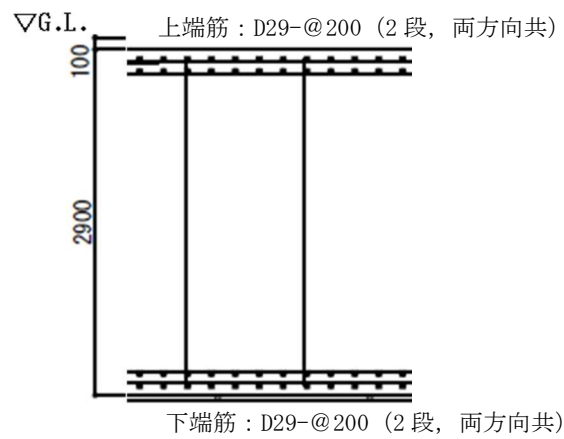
(7) 基础配筋图 (一般部) (单位：mm)
